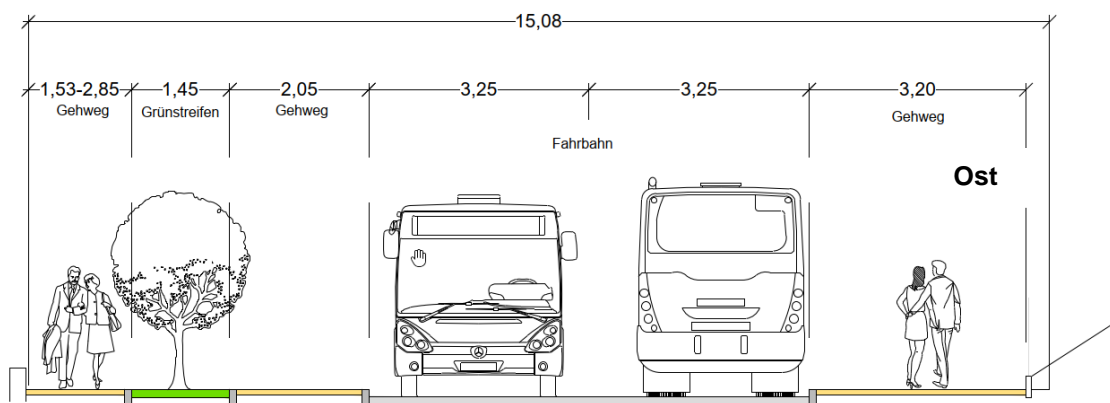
Geplanter Querschnitt Schleswiger Straße
